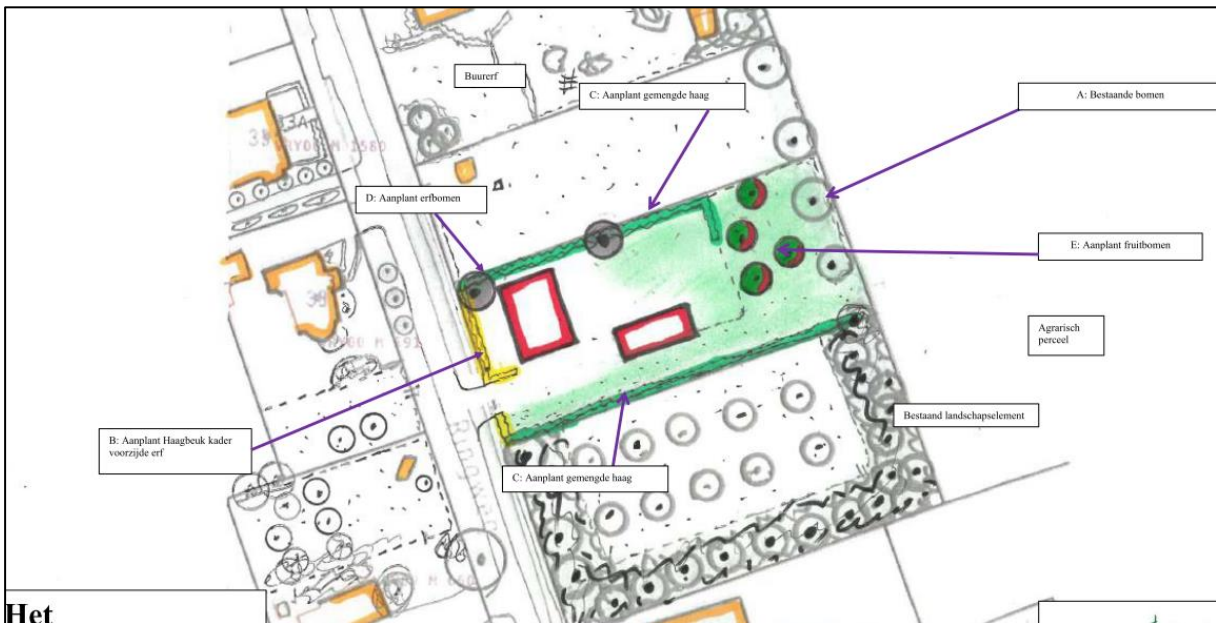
Uitsnede landschapsplan locatie E en F
